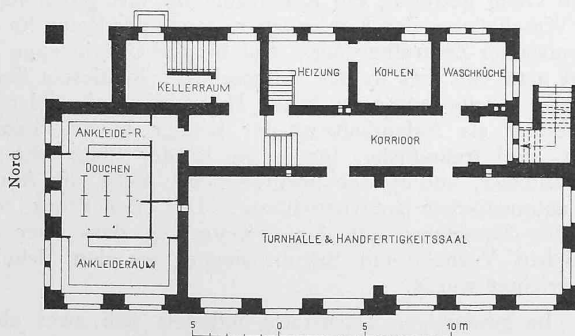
Grundriss vom Untergeschoss. — Masstab 1 : 400.
